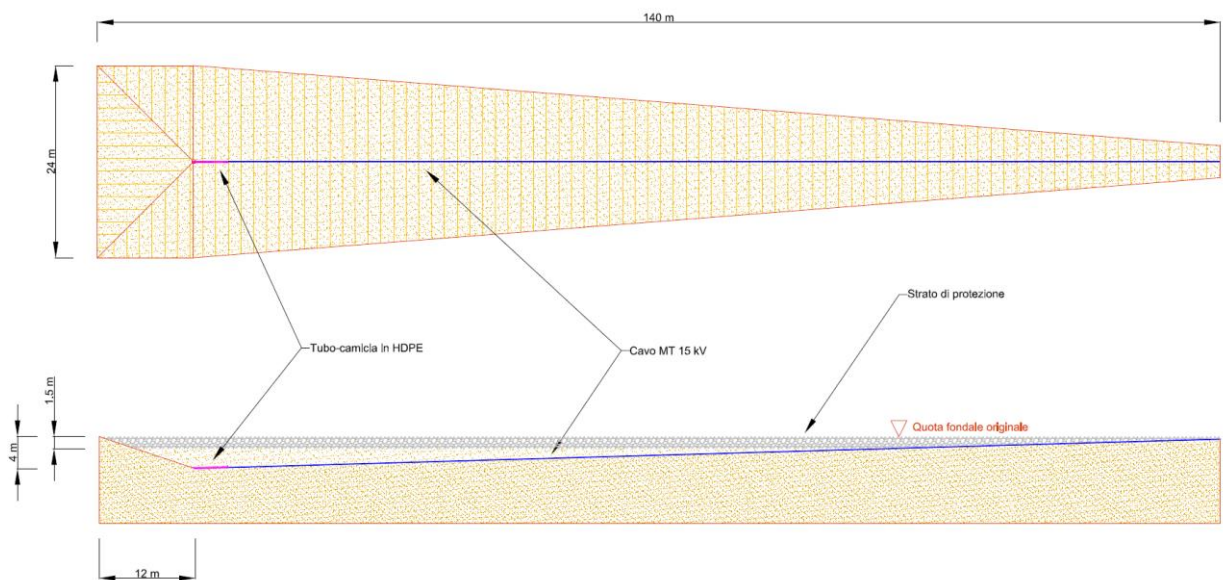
Vista in pianta ed in sezione del pozzo di entrata/uscita
